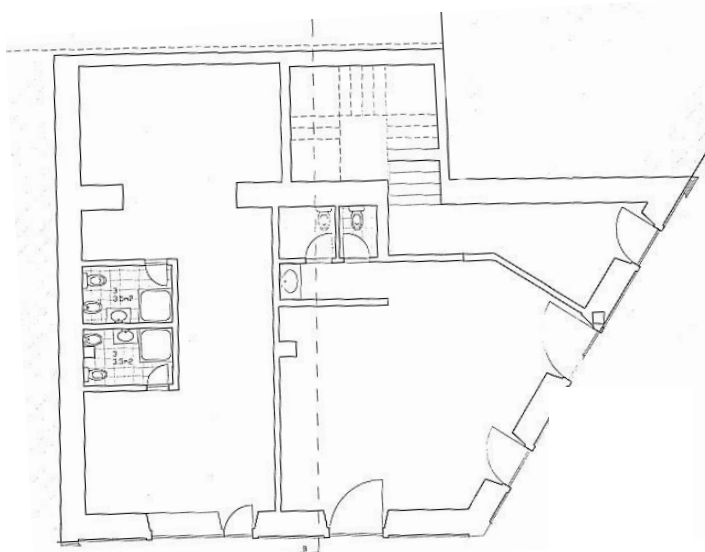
Planta rés do chão da proposta - Esc.1/200 – Autor do projeto
